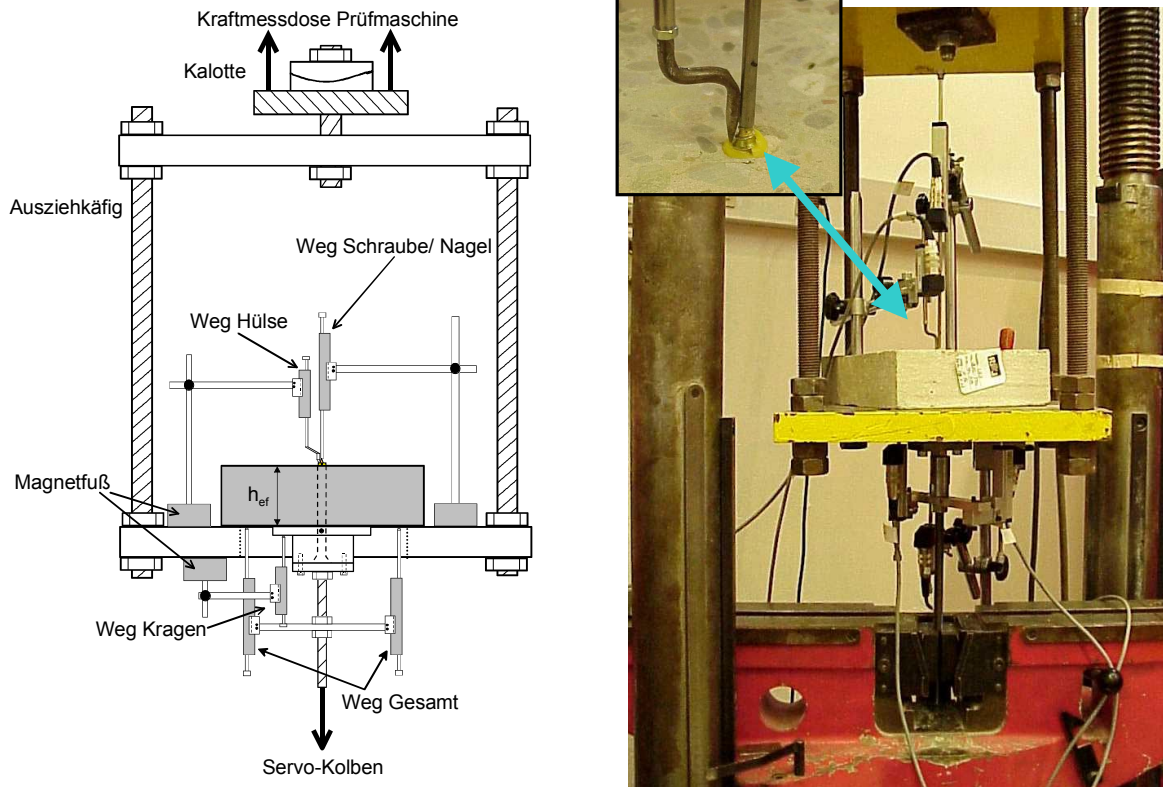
Versuchsaufbau für die Modellversuche mit Kunststoffdübeln im ungerissem Beton.
